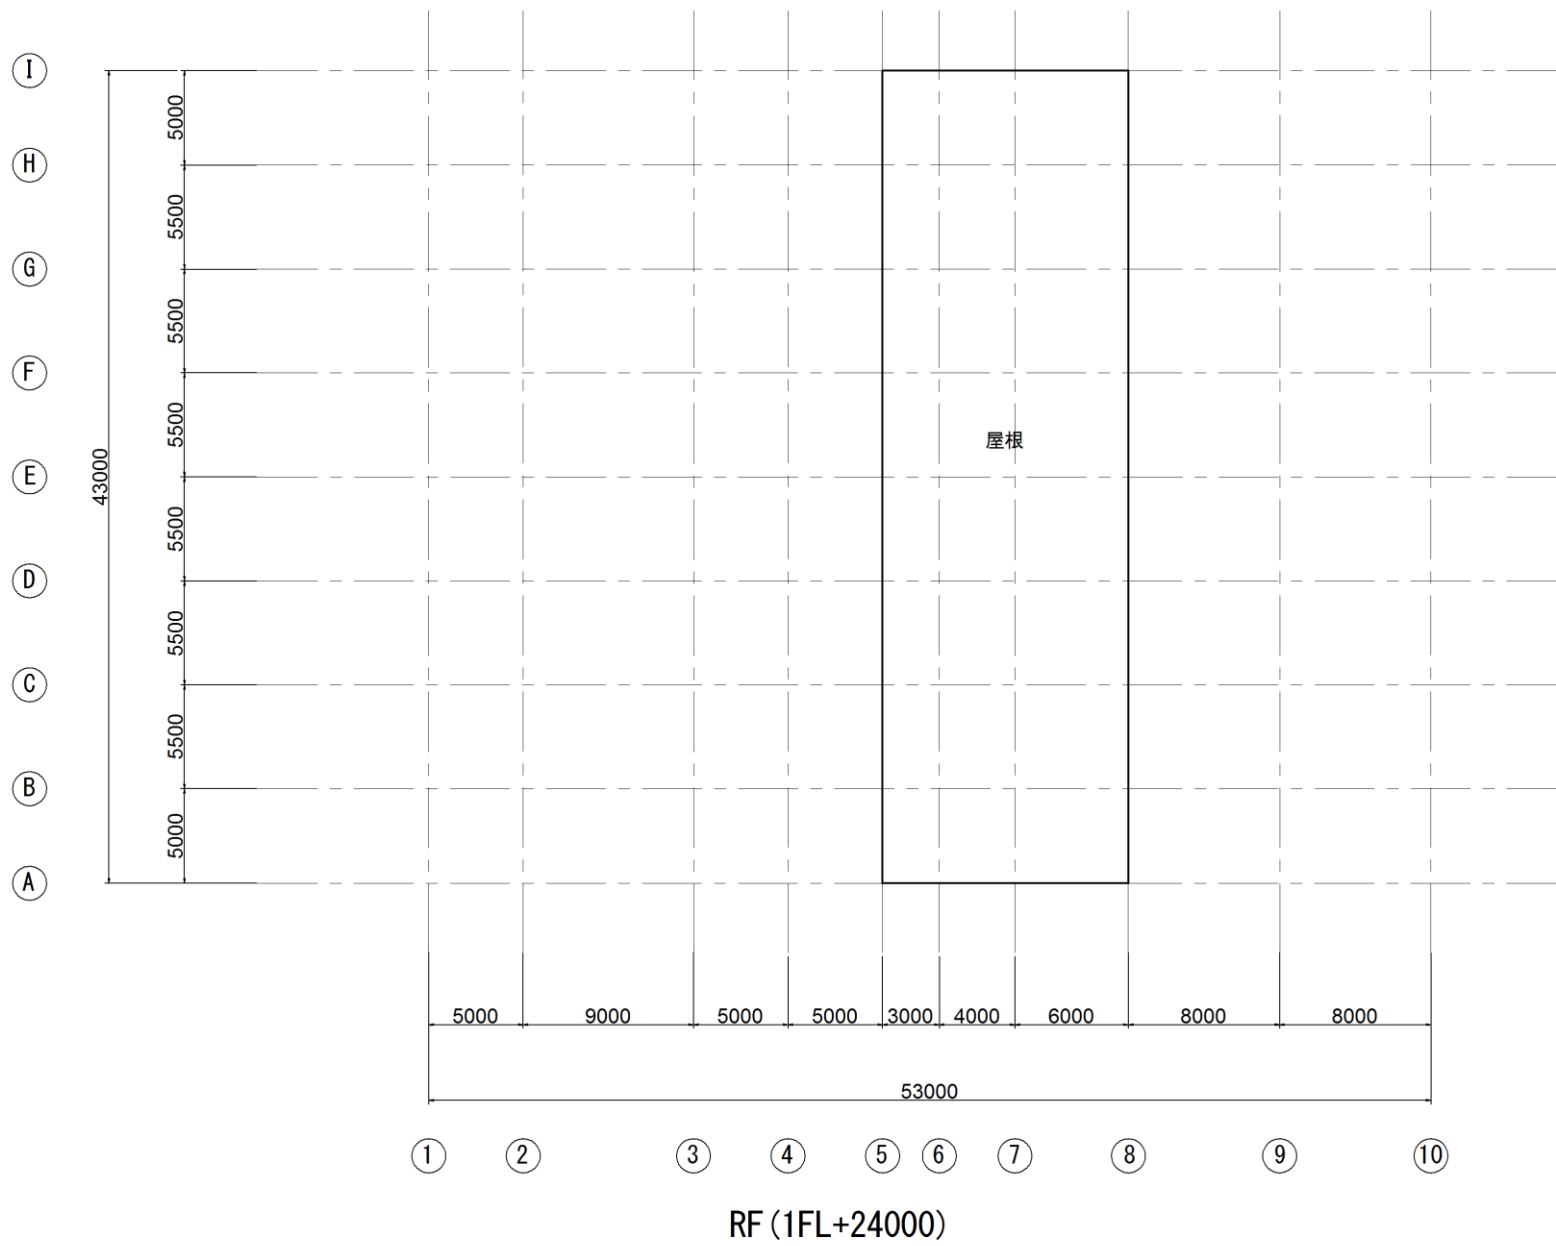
各階平面図 (屋根 : S = 1 : 400)
